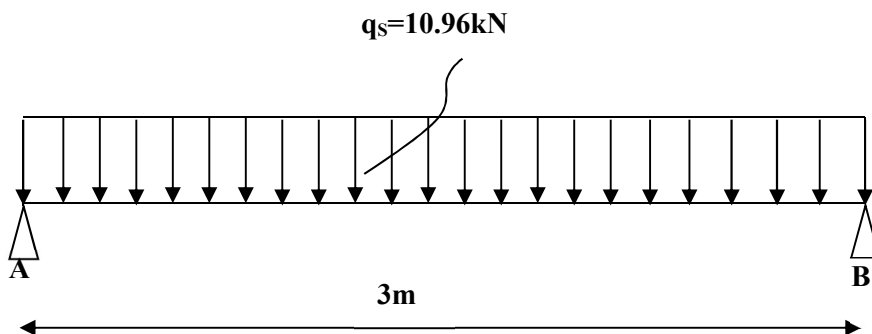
Schéma statique de la poutre de chaînage à l'ELS.
